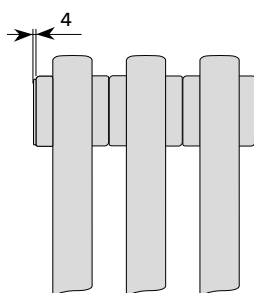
Längenzuschlag für geschweißte Deckel; der Längenzuschlag ist für beide Seiten des Heizkörpers zu berücksichtigen
